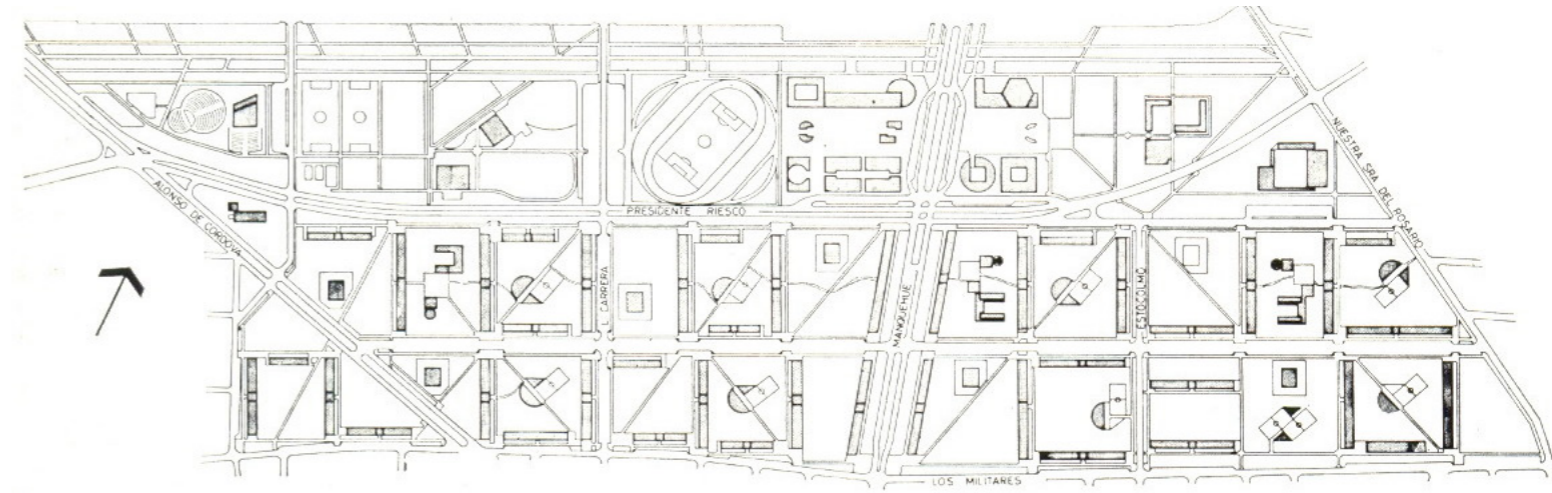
Planta de emplazamiento del conjunto, 1968. Fuente: Plataforma Arquitectura.
